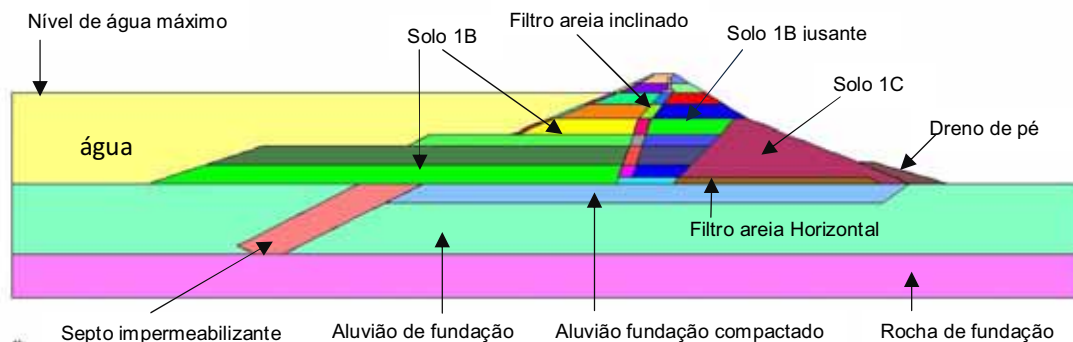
Materiais componentes da barragem na seção máxima estudada (maciço e fundação).
